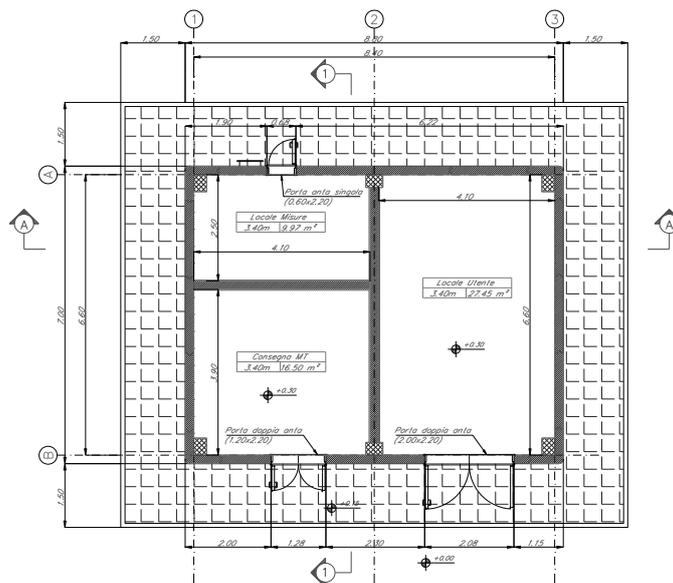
Vista planimetrica locale consegna al km 5+467,211
